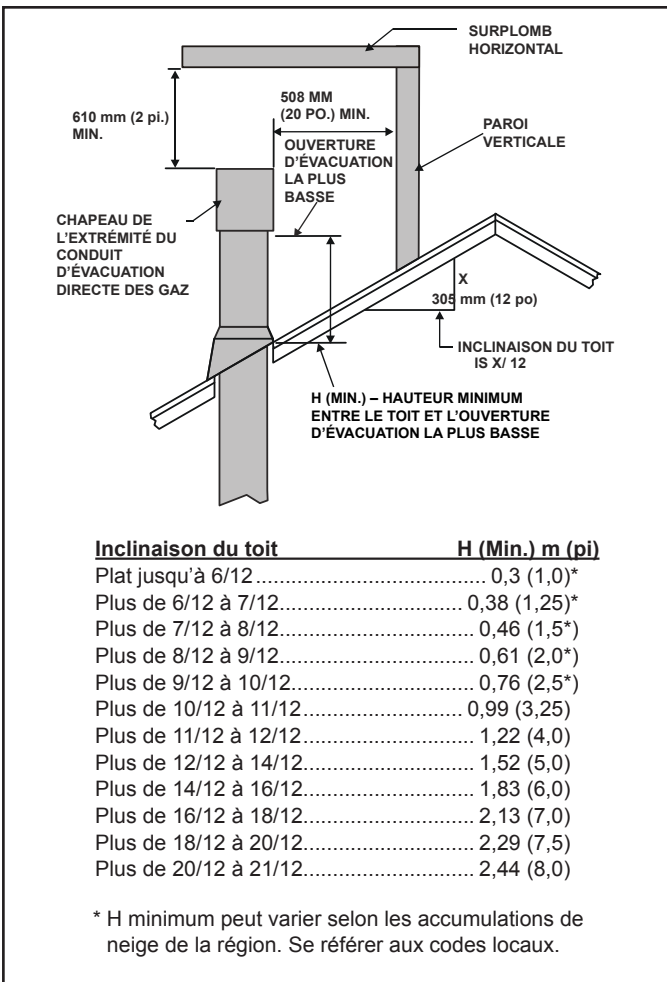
Hauteur minimum entre le toit et l'ouverture d'évacuation la plus basse
